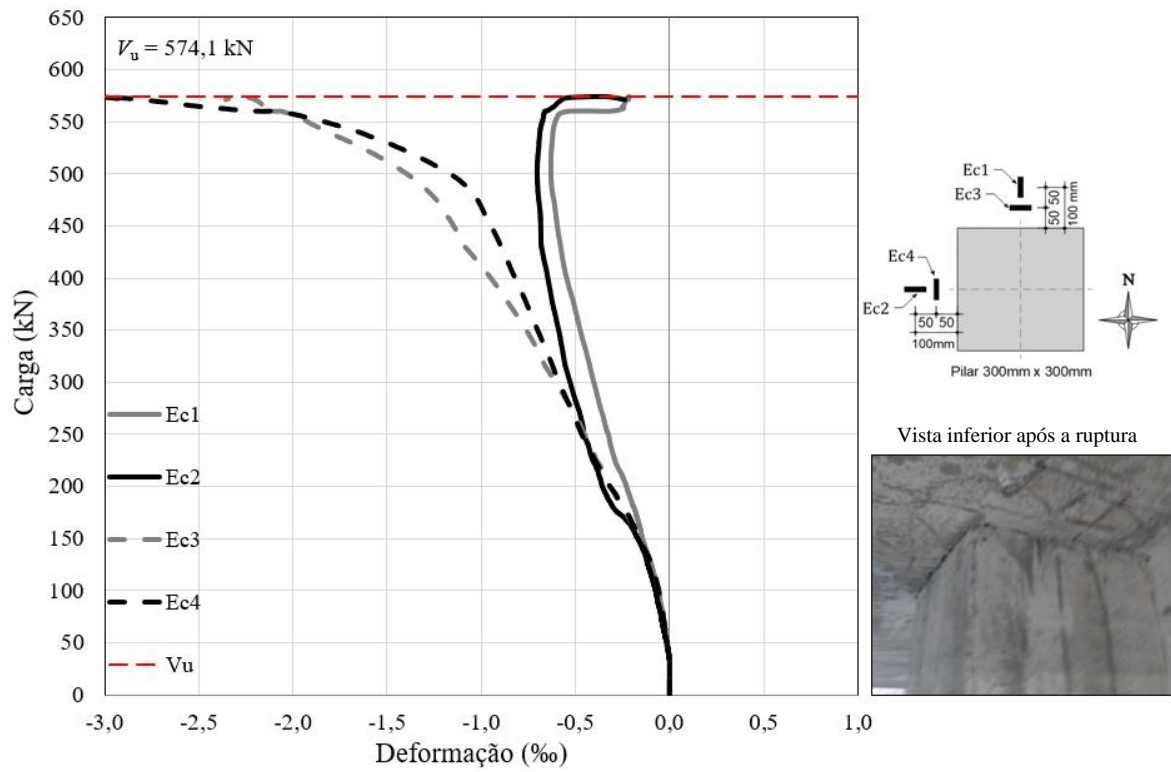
Deformações na superfície inferior do concreto da laje TA-05
